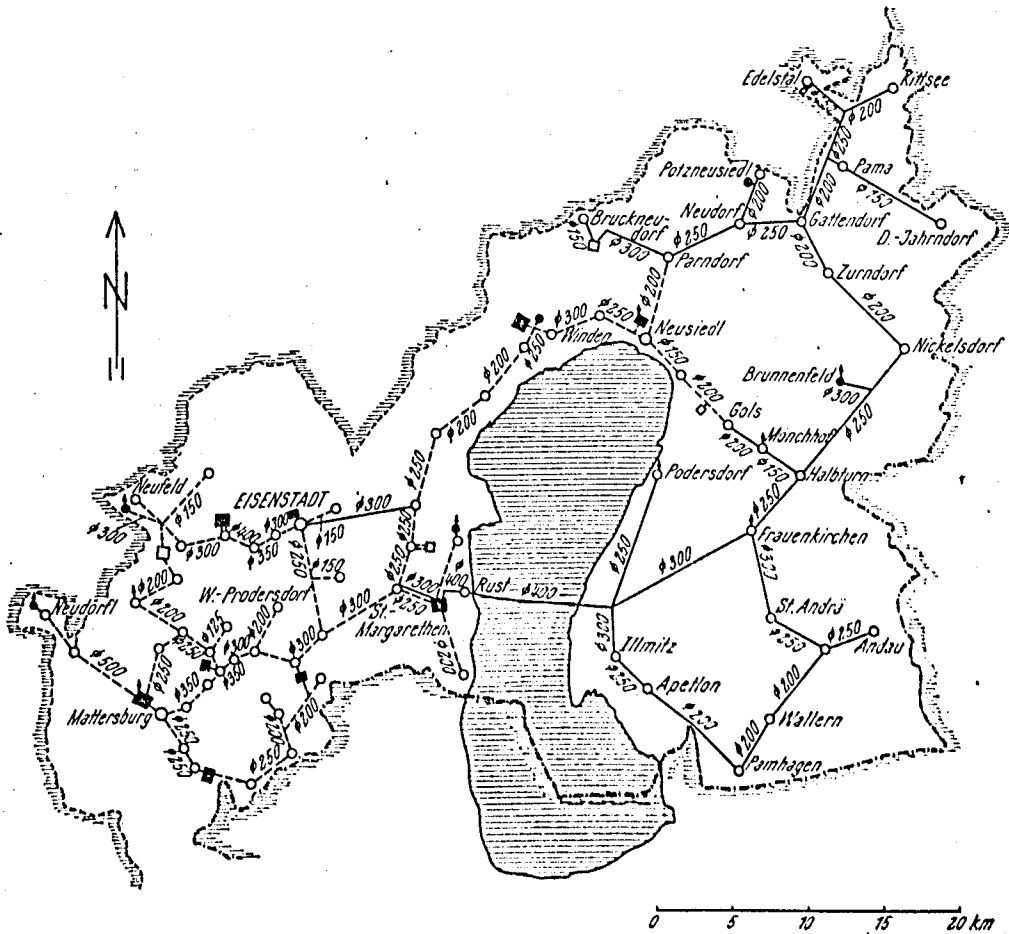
Lageplan des erweiterten Wasserleitungsverbandes „Nördliches Burgenland“
